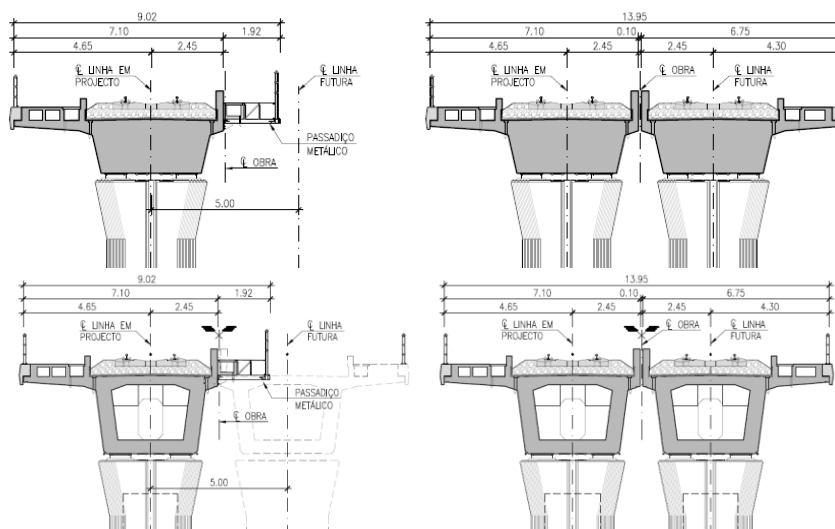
Secções transversais tipo (em cima para pontes até 35m de vão; em baixo para a Ponte do Lucefece, com 40m de vão; do lado esquerdo, obras já executadas; do lado direito configuração após futura duplicação).
